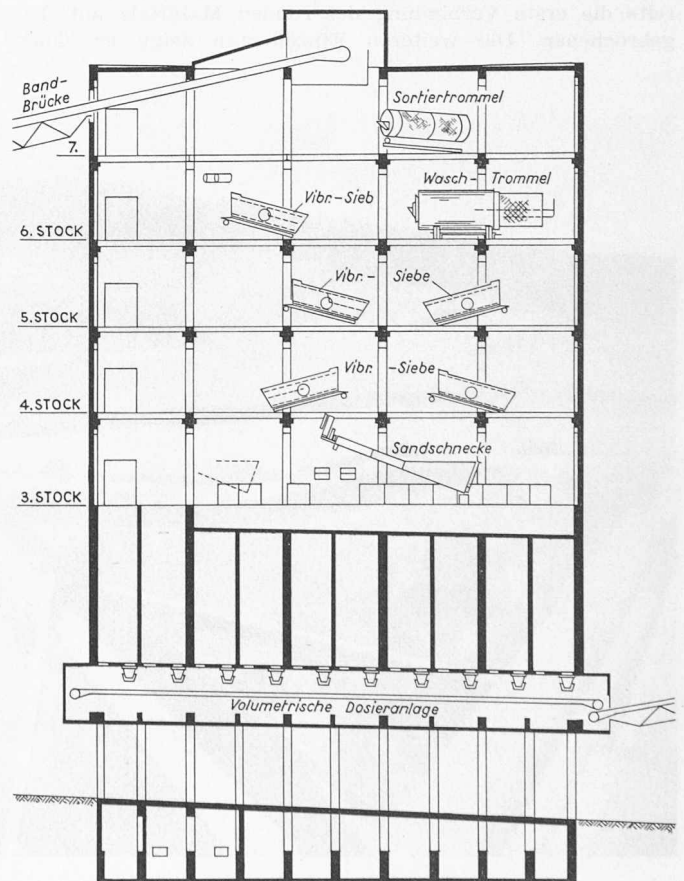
Längsschnitt 1:350 durch den Hauptbau
